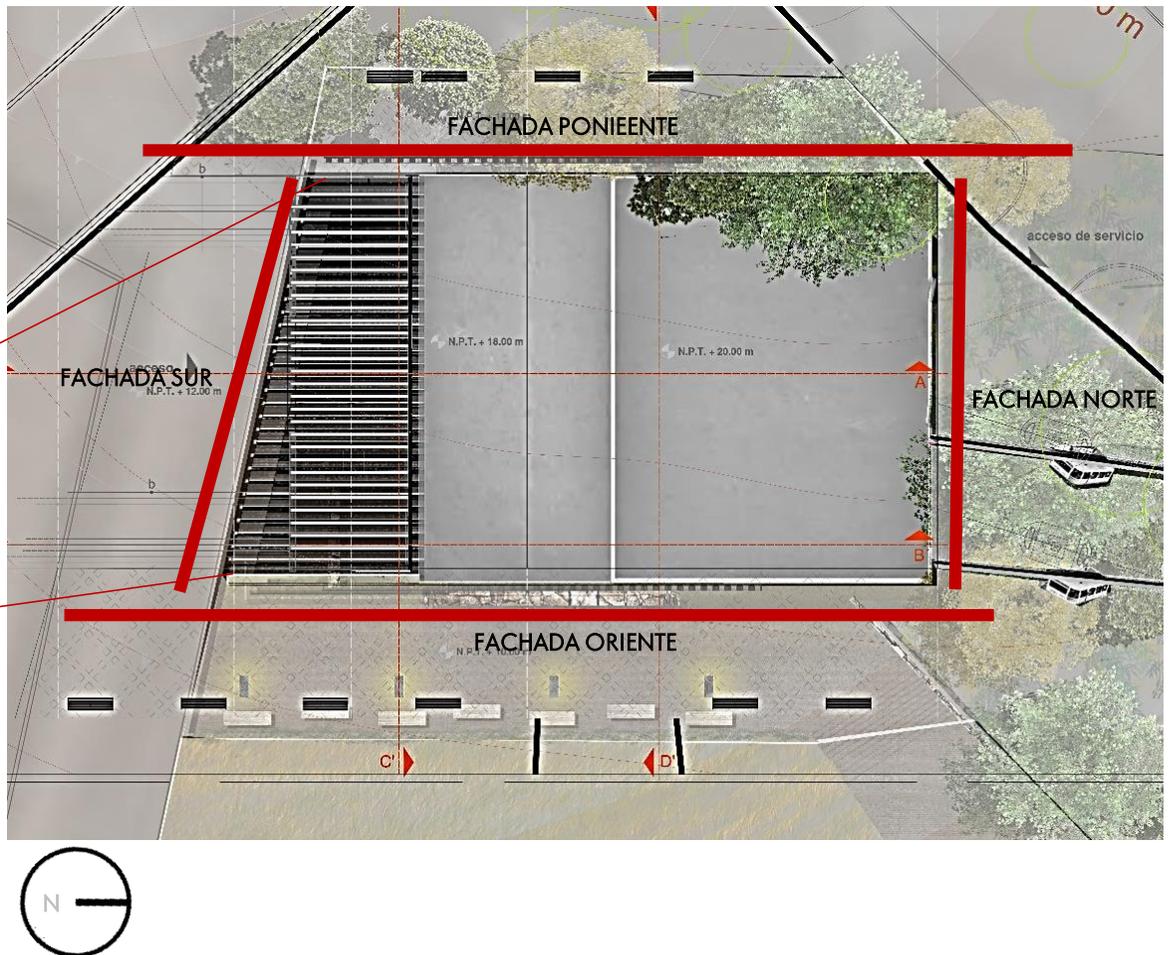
Ubicación de la estación en el conjunto y ubicación de las fachadas en la estación. .
